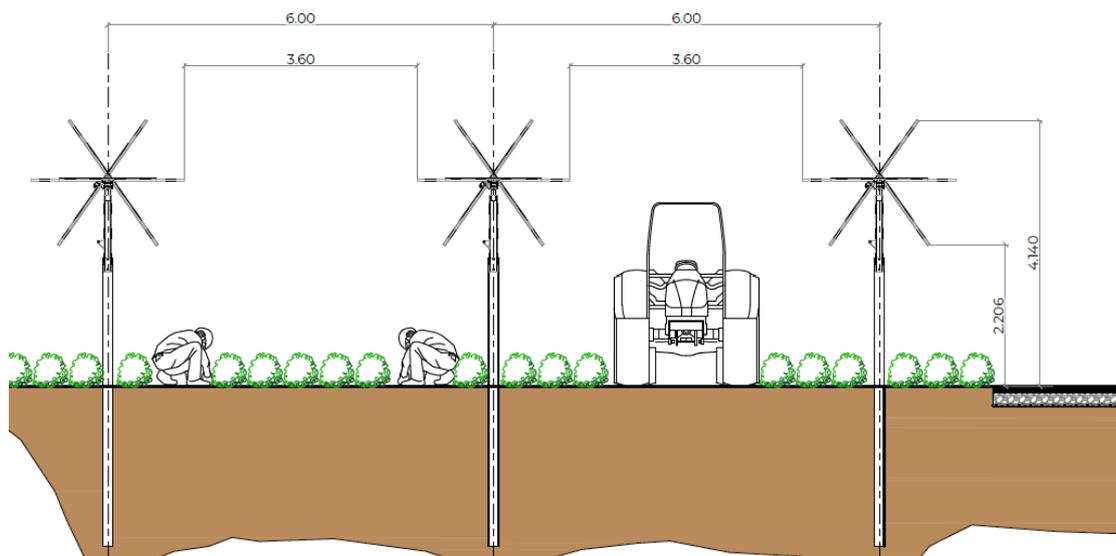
Sezione struttura sostegno moduli con palo di fondazione che raggiunge una profondità di 2 m. Altezza minima da terra 2,2 m, altezza massima da terra 4,14 m
